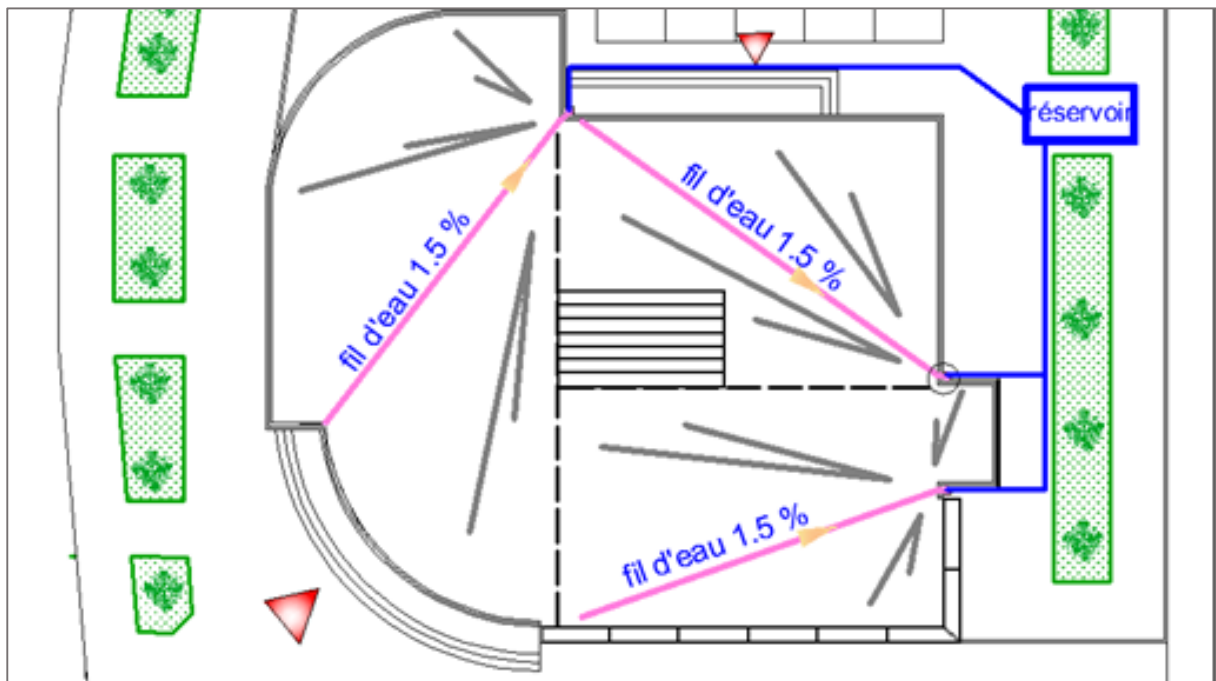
plan d'évacuation des eaux pluviales, AUTEURS
